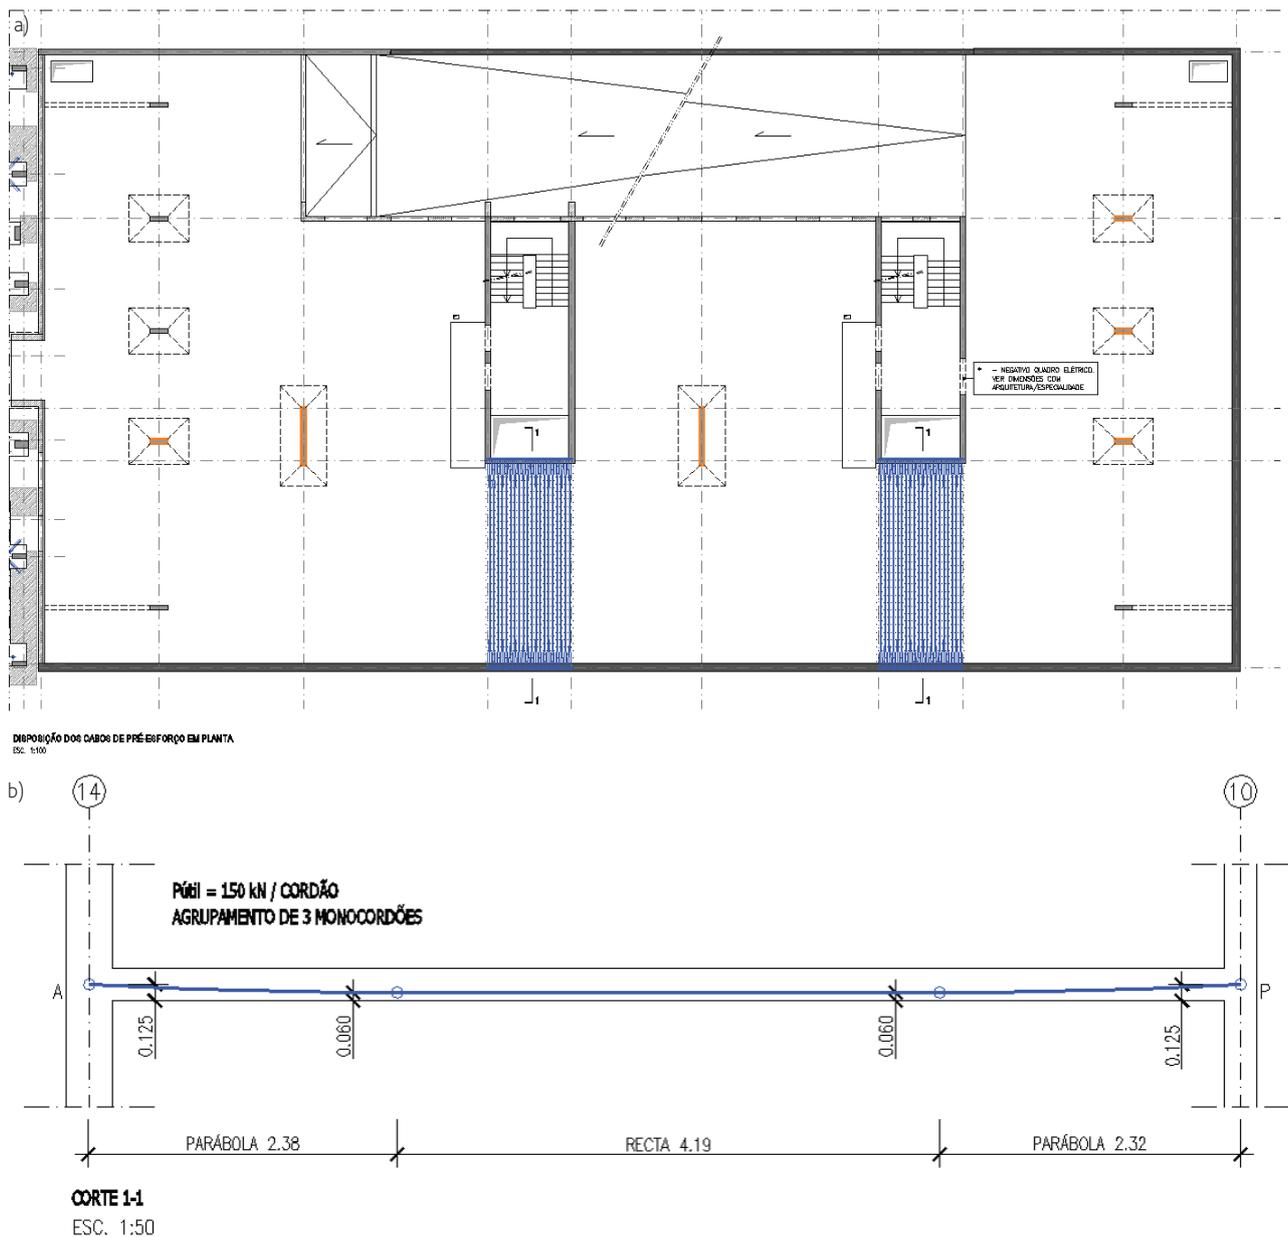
Pré-esforço nas lajes dos pisos enterrados. a) Distribuição em planta; b) Alçado.
